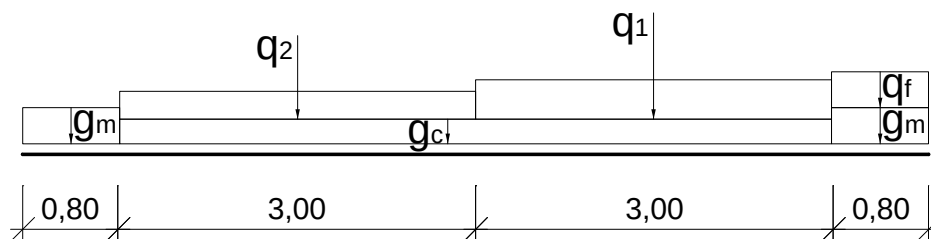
2^a condizione: carichi sulla sezione trasversale dell'impalcato
